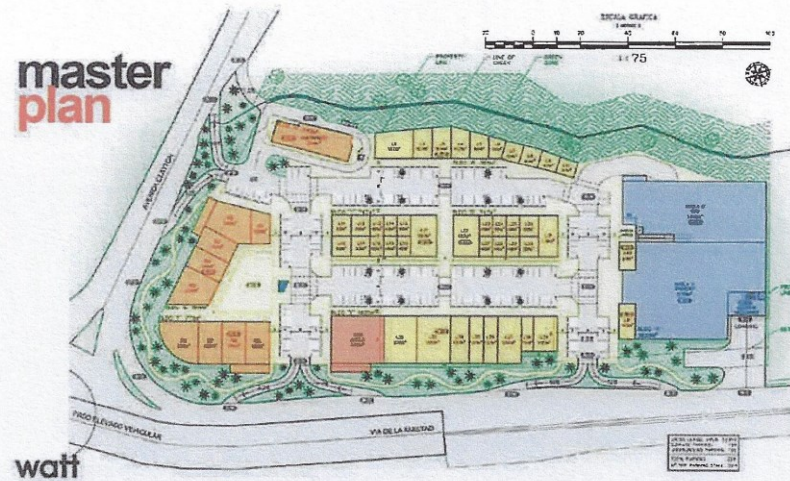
Plan Maestro Clayton Station. Fuente: Equipo diseñador
